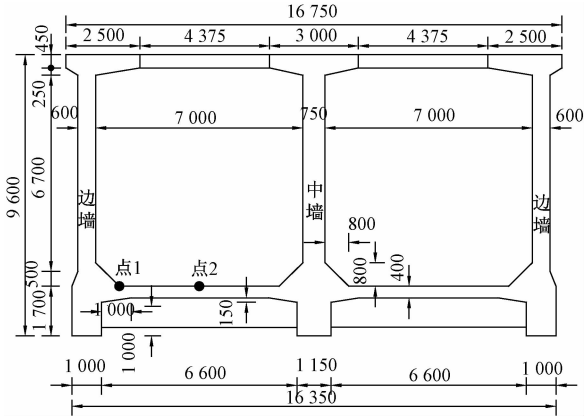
矩形槽(底板带肋)横断面图(尺寸单位:mm)
